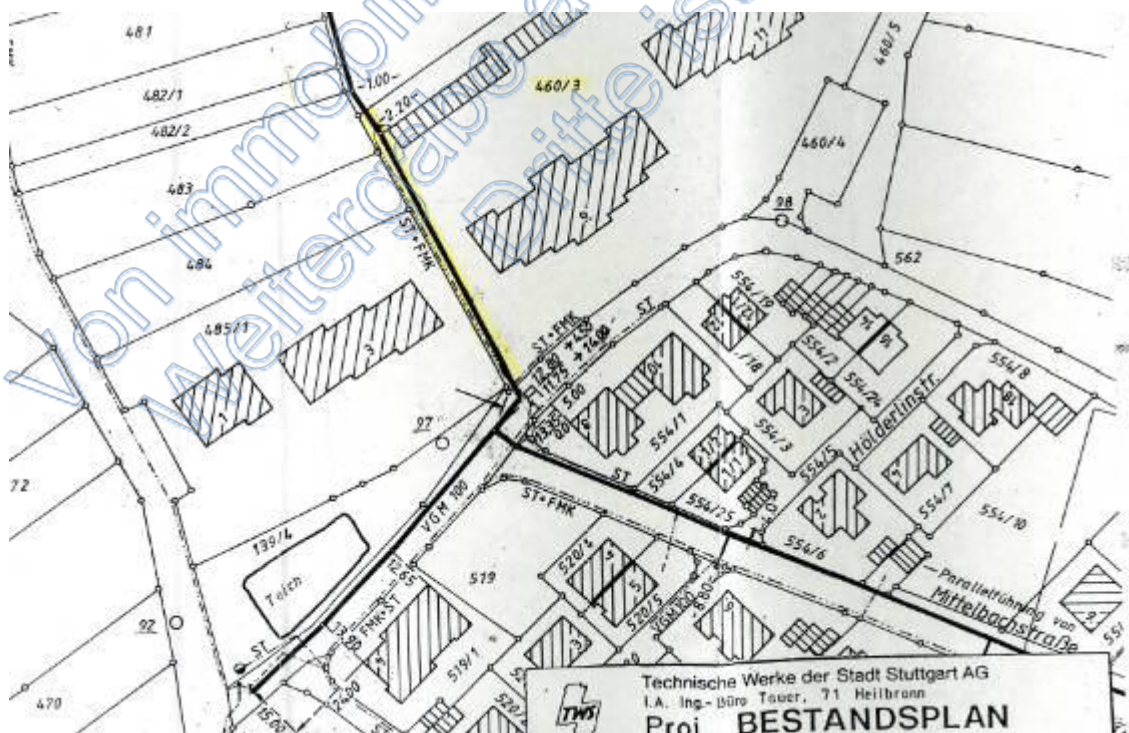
Lageplan zur Bewilligung UR Nr. 178/1988; Quelle: Grundbuchzentralarchiv BW
